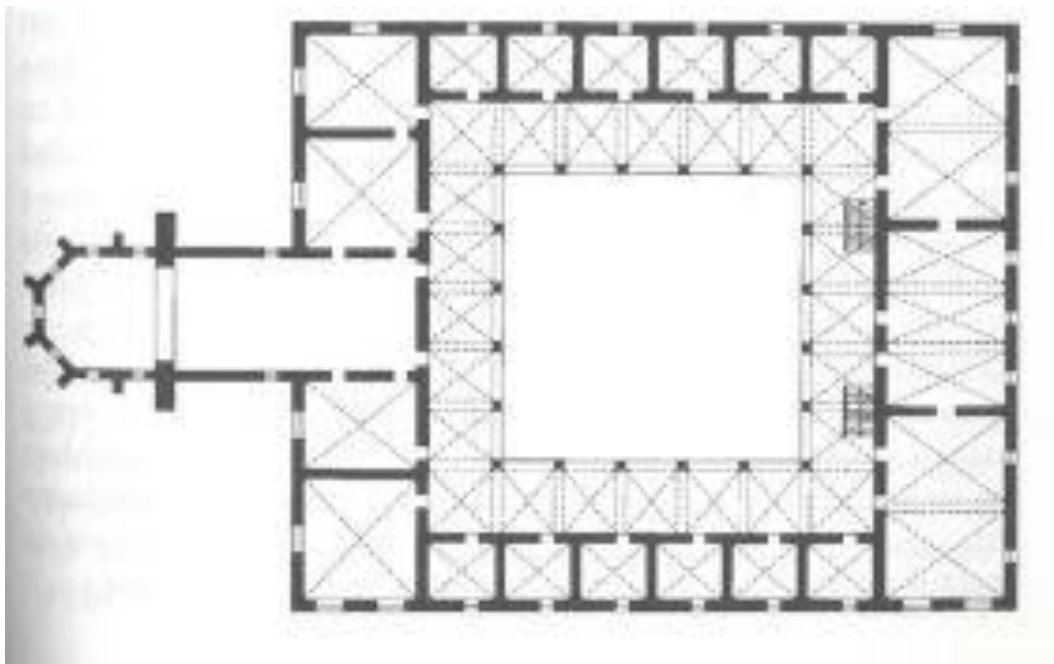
Pianta piano terra Collegio di Spagna - Fonte: www.wikipedia.it
